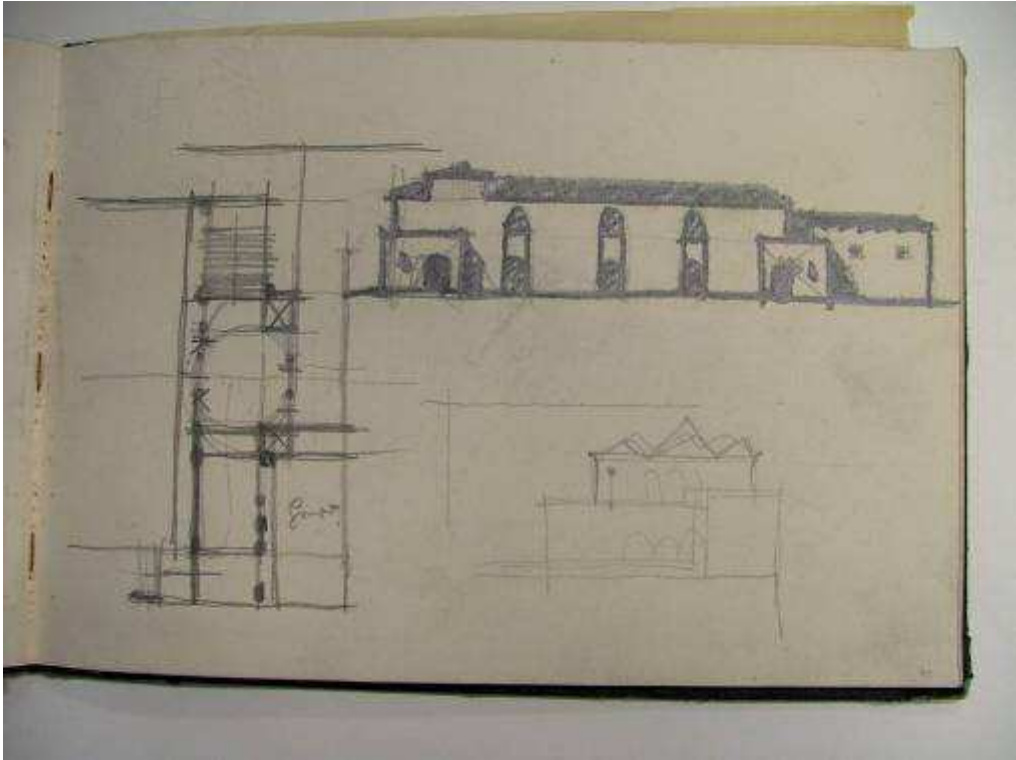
Otto Strohmayer, Grundriss und Ansichten, Stadtkino, Hallein, undatiert (HSS, INR 1674-1675).
